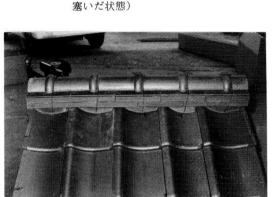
施工状況 (対象外の下地材通気口を 塞いだ状態)
